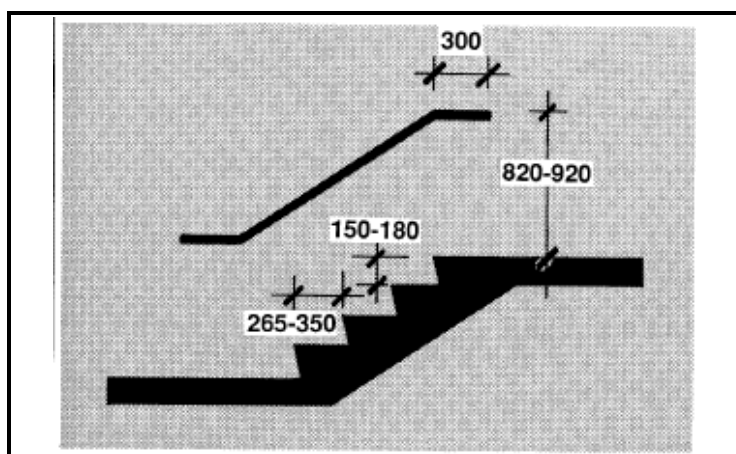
Les dimensions indiquées rendent l'escalier facile à emprunter. À noter la main courante qui se prolonge au-delà du bas et du sommet de l'escalier.
